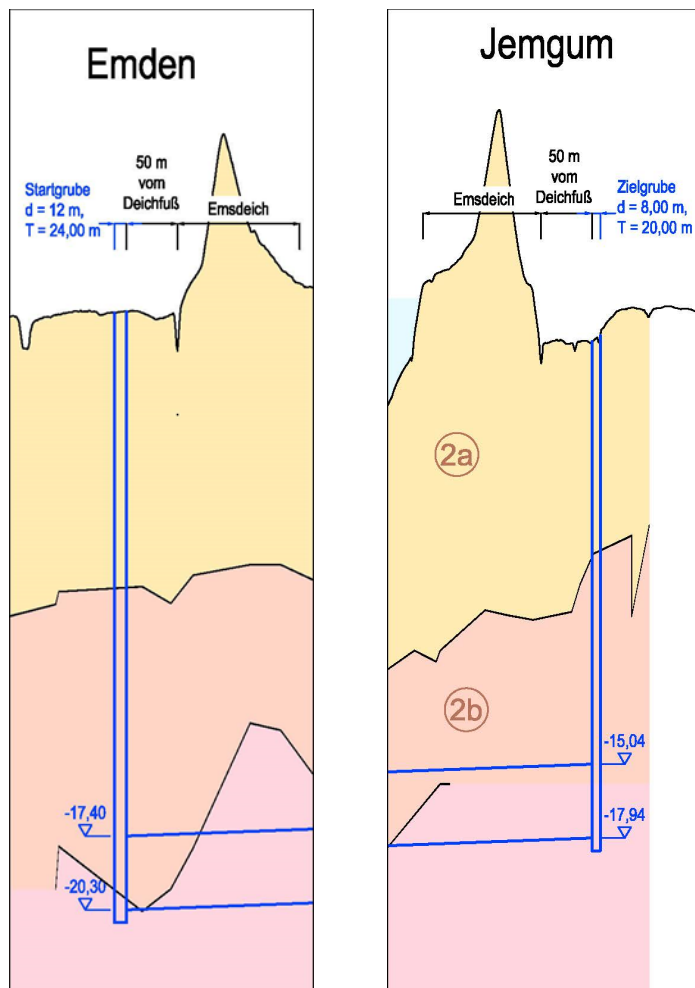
Detailabschnitt Längsschnitt des Rohrvortriebes mit Schächten an den Tunnelportalen
